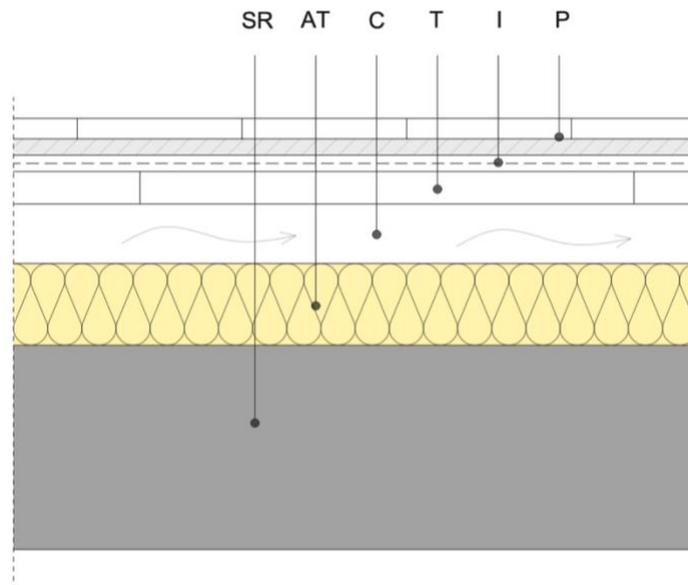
Cubierta ventilada. Leyenda: SR Soporte resistente; AT Aislante térmico; C Cámara de aire; T Tablero; I Impermeabilización P Protección.
